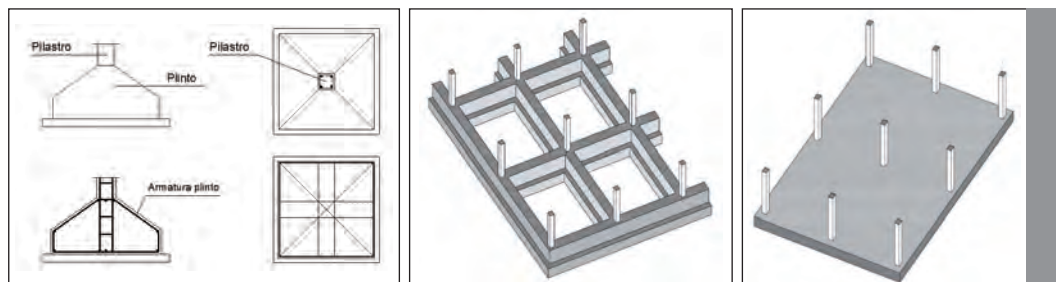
Plinto di fondazione. - Figura 4. Fondazioni a graticcio. - Figura 5. Fondazioni a platea.
